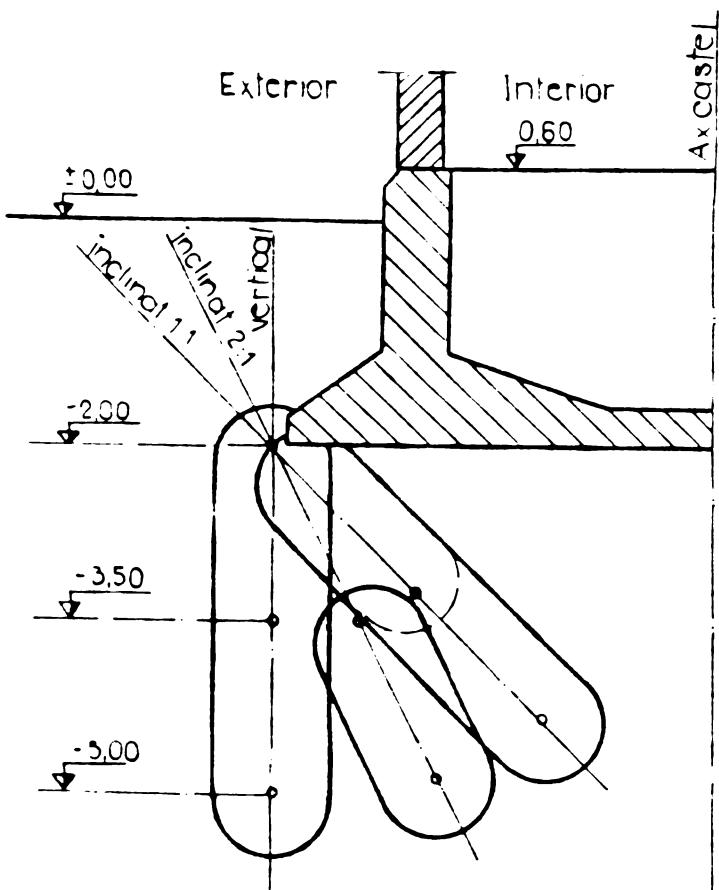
Secțiune transversală prin zona consolidată din jurul castelului
